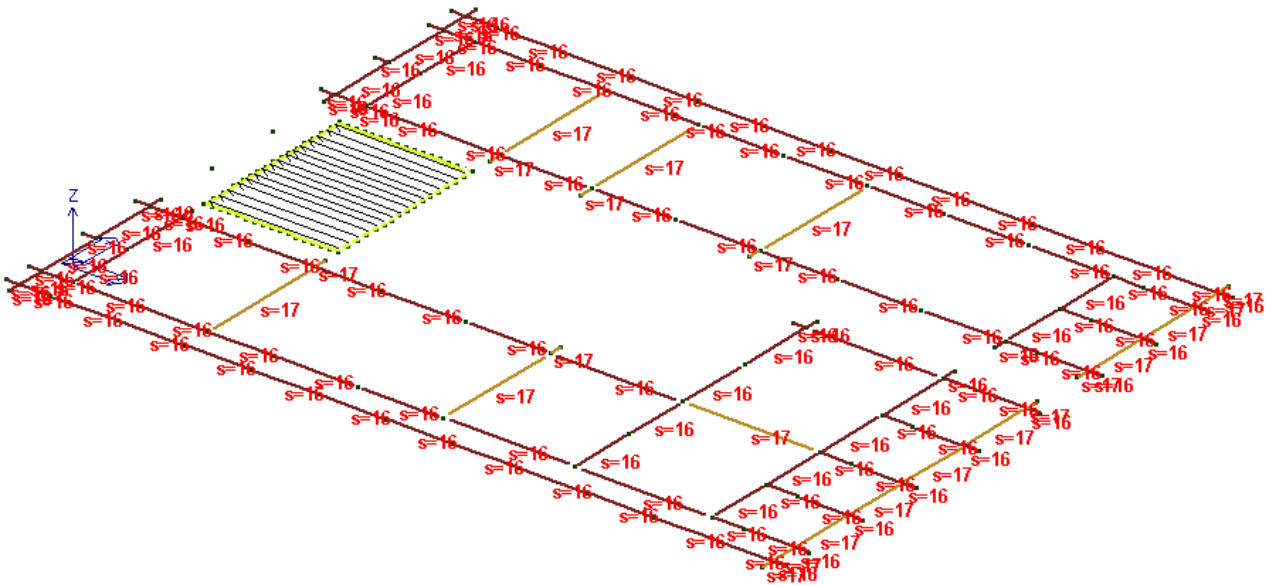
2 – Codice “Id” elementi strutturali in c.a. in fondazione
